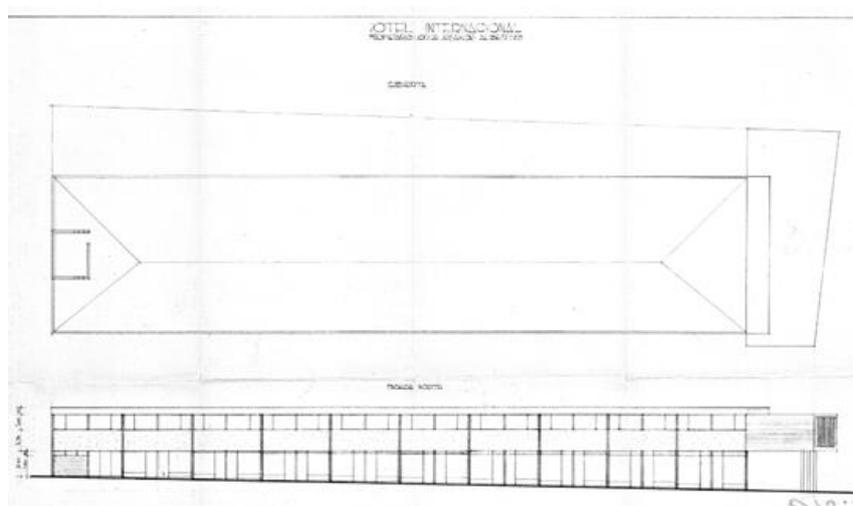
Plano no original del proyecto y elevación poniente, Corte transversal A-A
